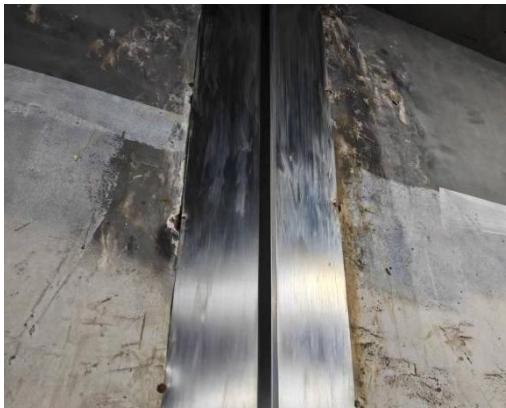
后浇带两侧混凝土开裂渗漏
